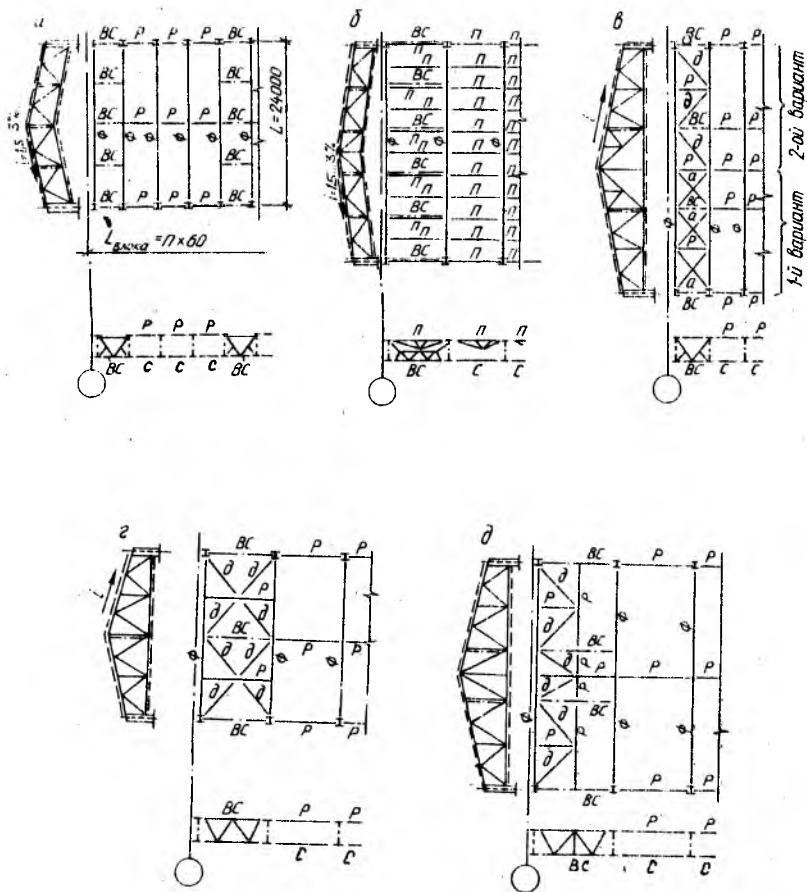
Примеры решения связей по верхним поясам стропильных ферм:
